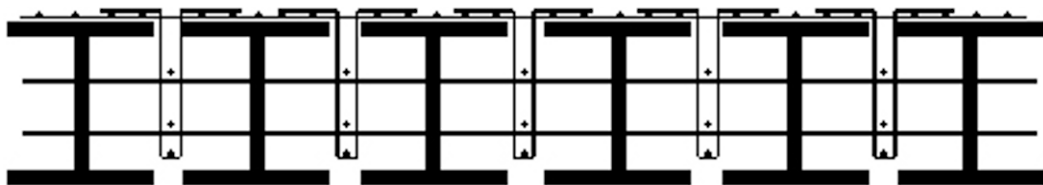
Prinzipschnitt eines WIB-Überbaus (Walzträger im Beton), der Stahlträger und Betonstähle zeigt
